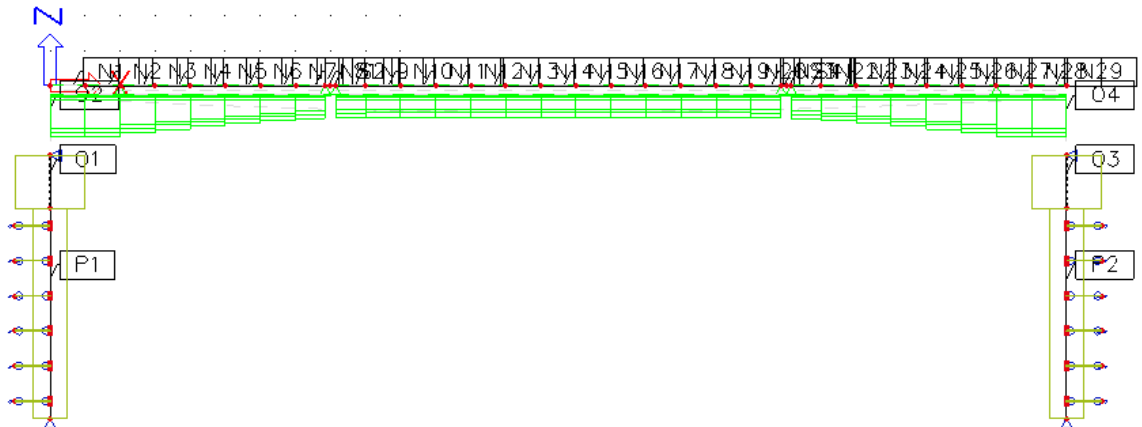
1. Fáze výstavby – betonáž pilot, čas 0. den
